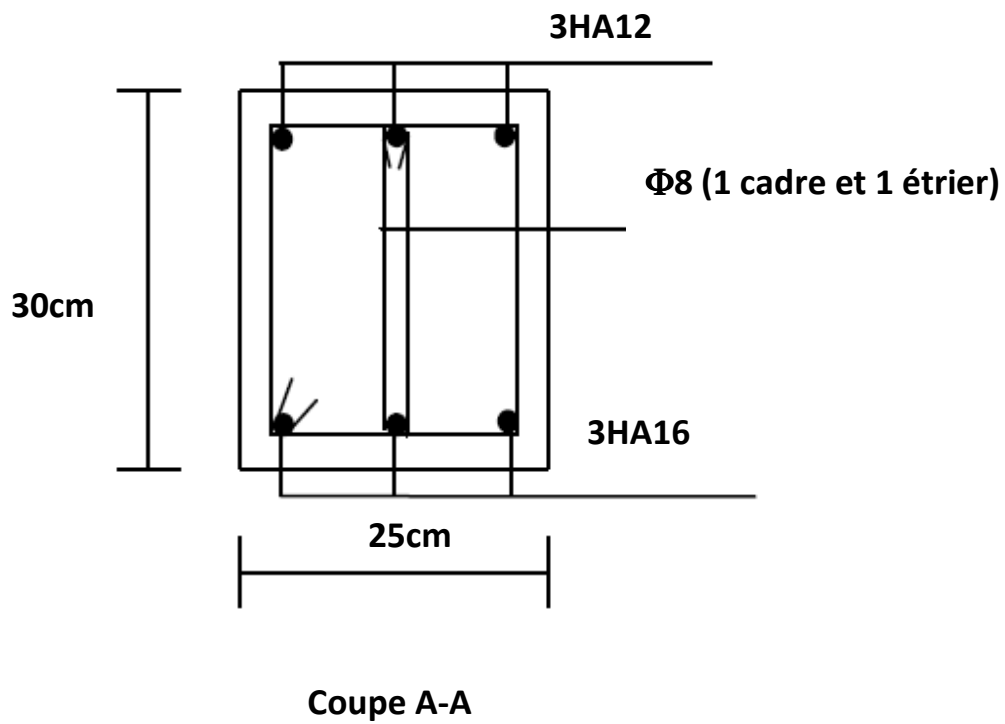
Schéma de ferrailage de la poutre palière.
